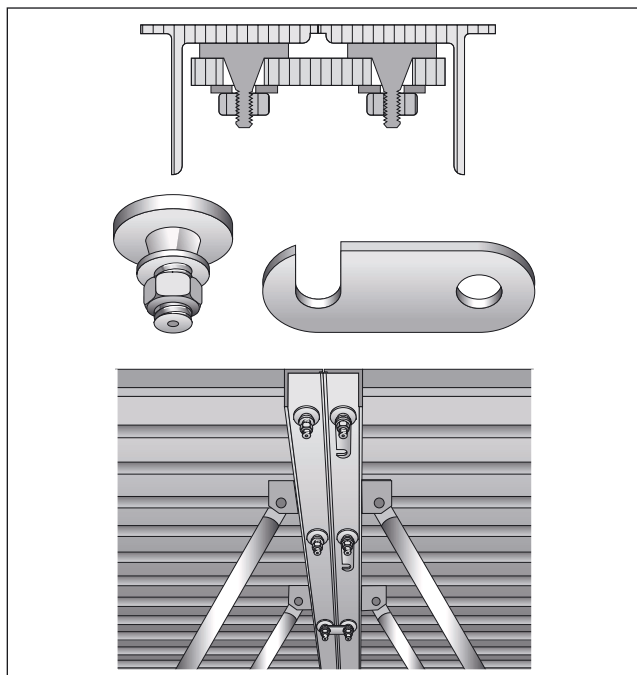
Dispositivi di collegamento per il montaggio di casseri a tunnel.
